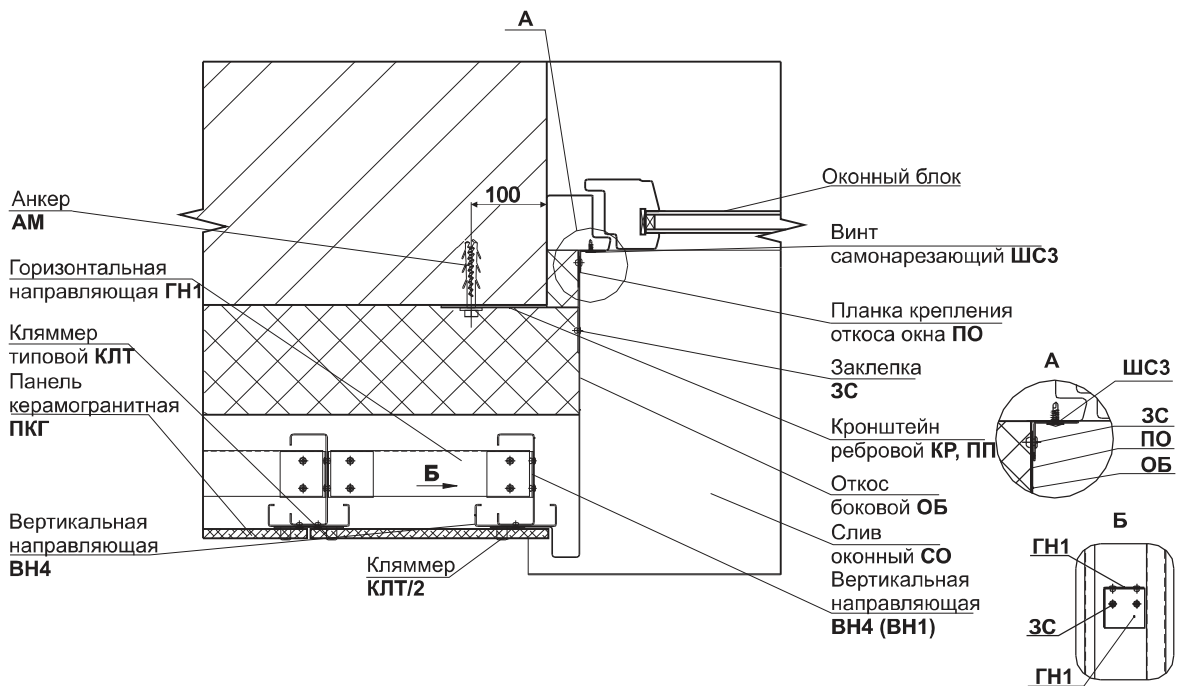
Узел облицовки бокового откоса. Вариант крепления системы к междуэтажным перекрытиям. Вариант 1.
